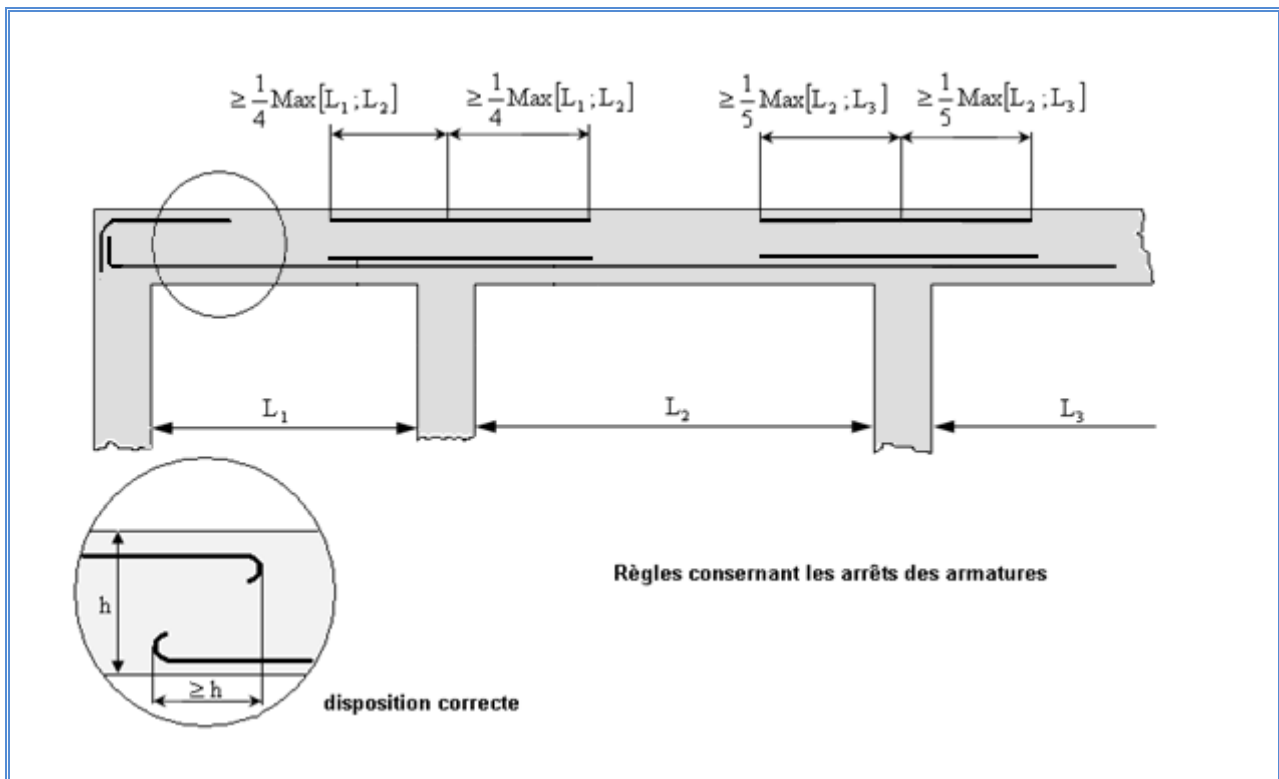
Disposition des armatures pour les poutres non porteuse.
